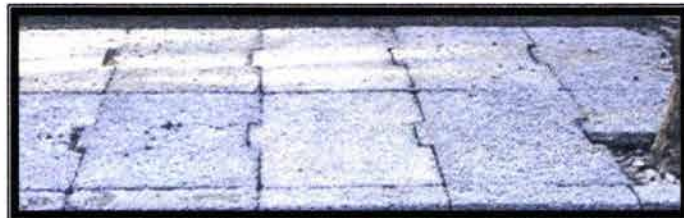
PISO DE ESOCRETO CON PIEZAS PREFABRICADAS
